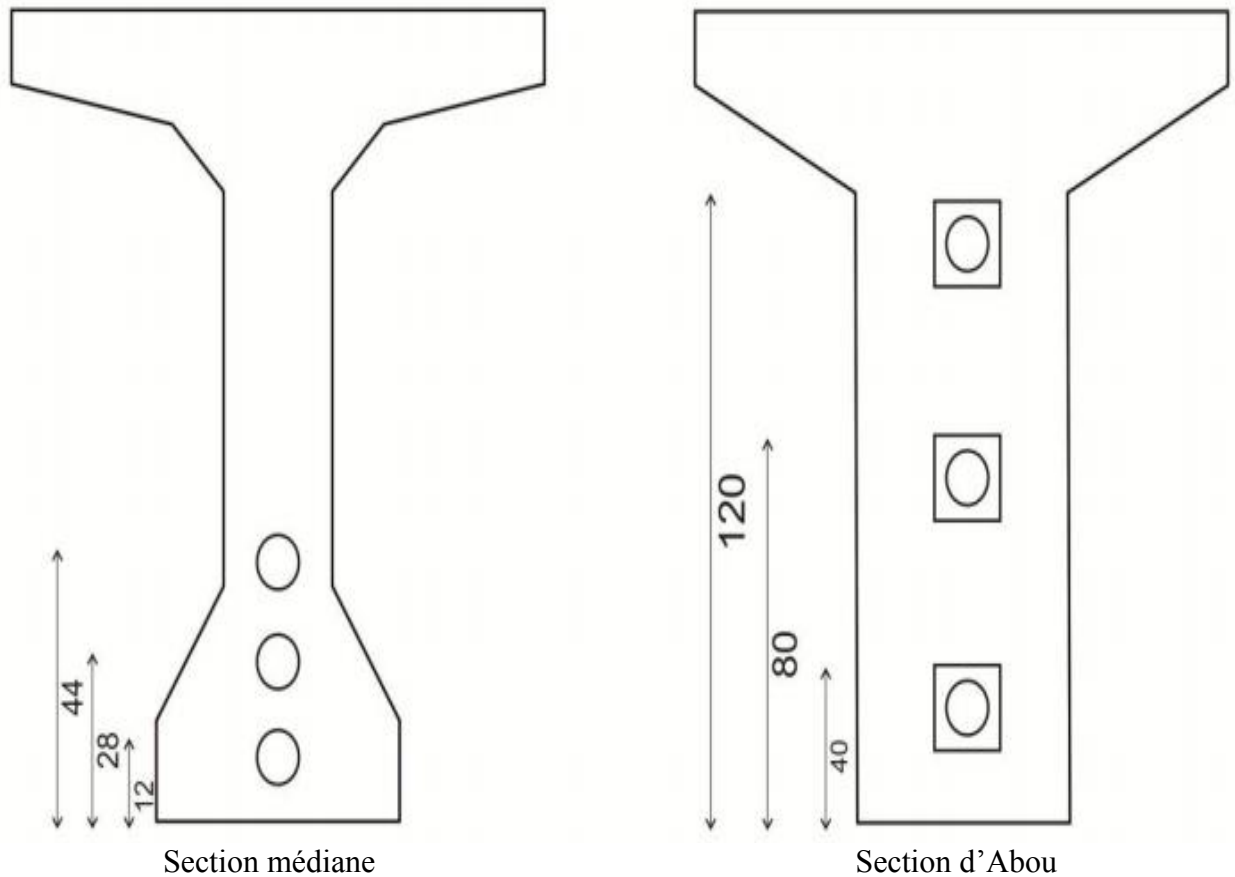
L'emplacement des câbles dans les sections de la poutre
